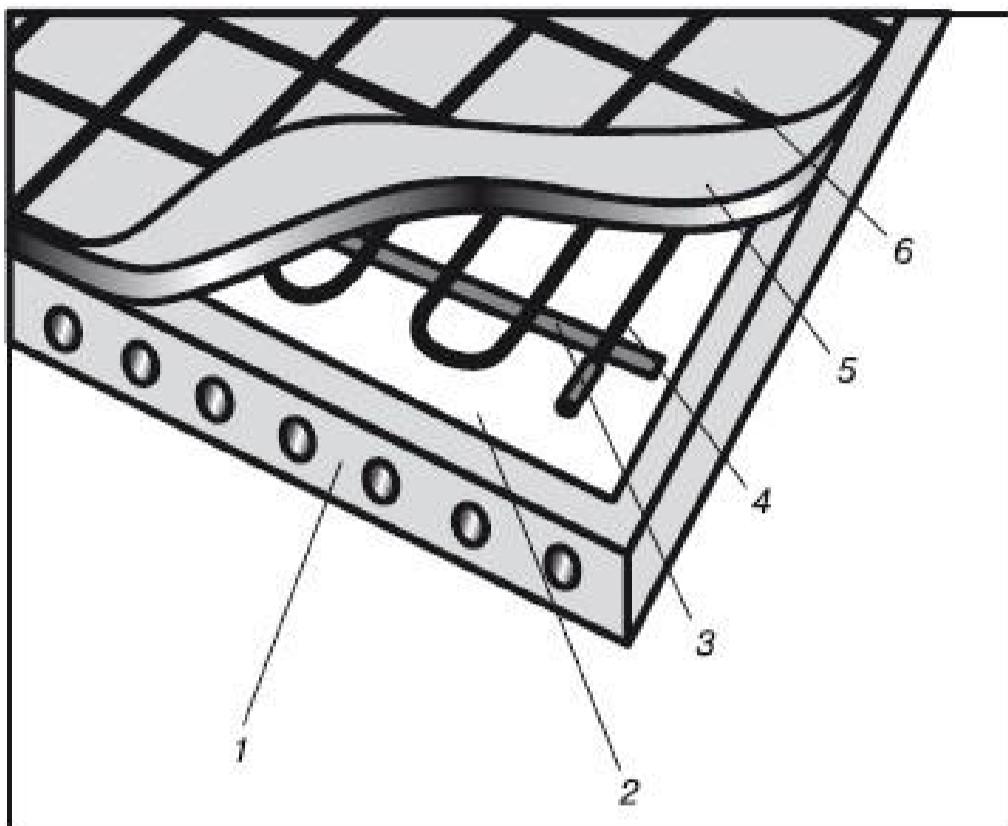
Система «теплый пол»: 1 – основа пола (перекрытие); 2 – теплоизоляция с фольгой; 3 – монтажная лента; 4 – нагревательная секция; 5 – цементно-песчаная стяжка; 6 – декоративное покрытие
